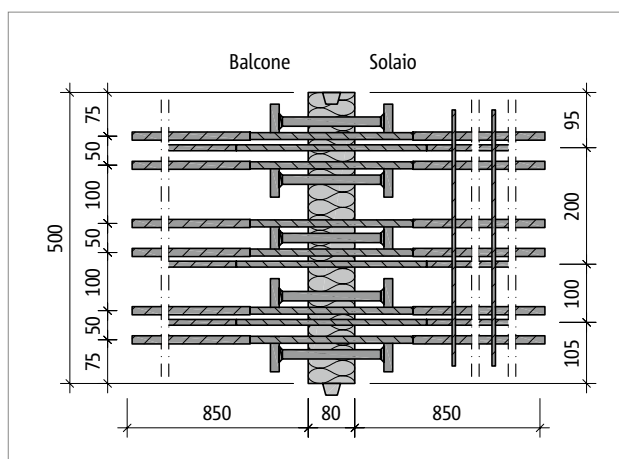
Schöck Isokorb® T tipo K-M12-V1: pianta del prodotto
